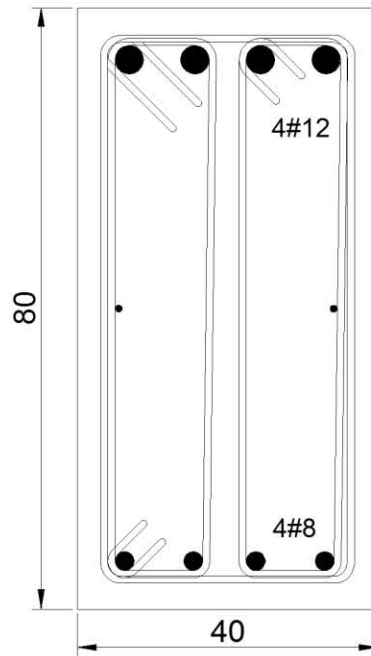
Detallado de acero longitudinal y estribos en vigas
